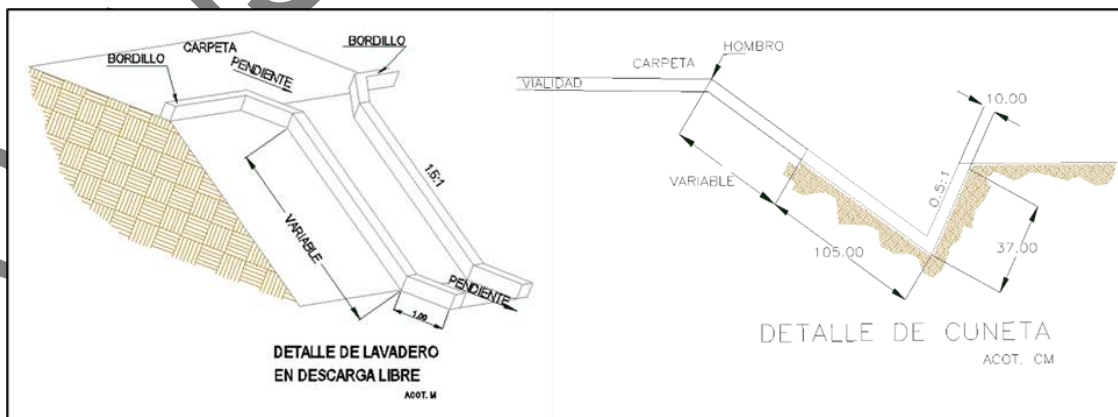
Detalles de lavadero, bordillo y cuneta.
